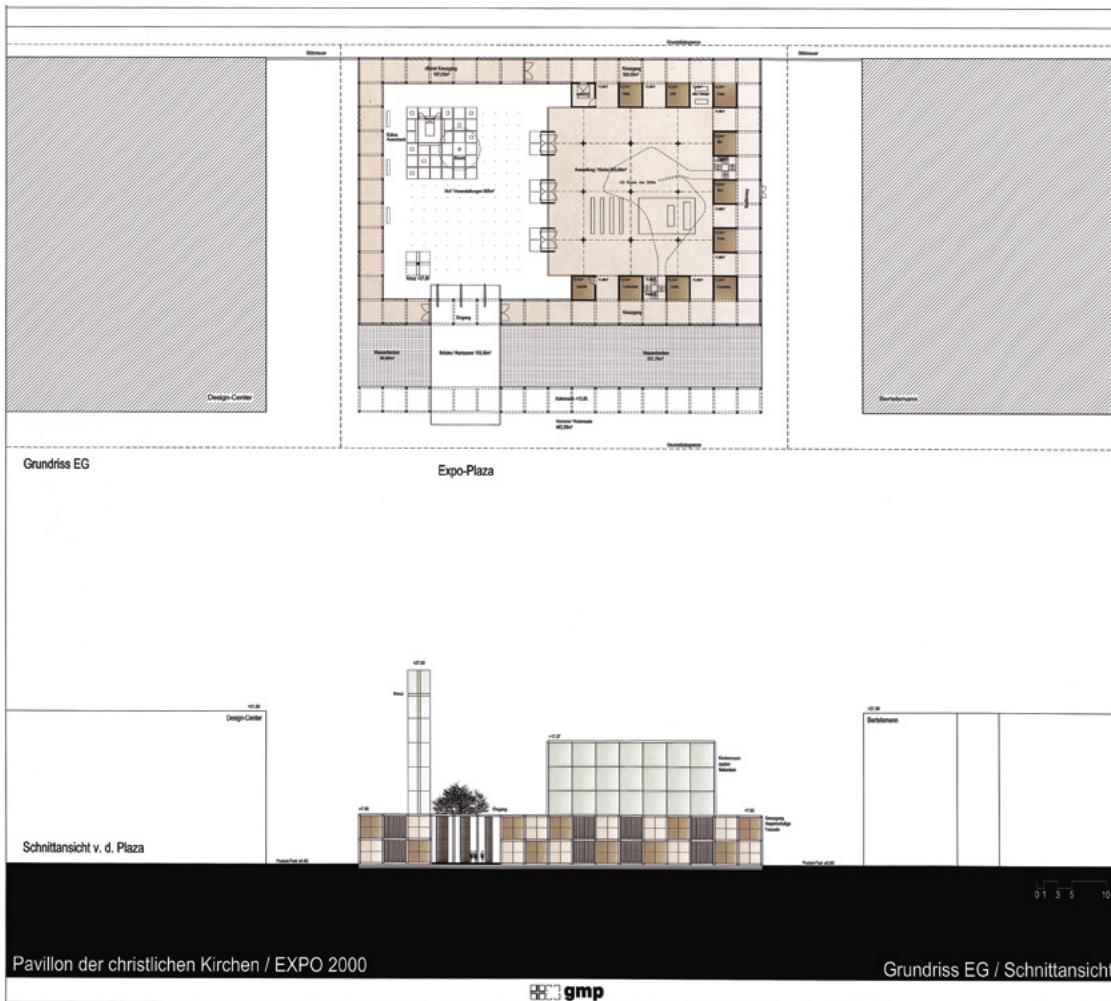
| Grundriss des Pavillons auf der Expo in Hannover, Erdgeschoss © gmp Architekten
